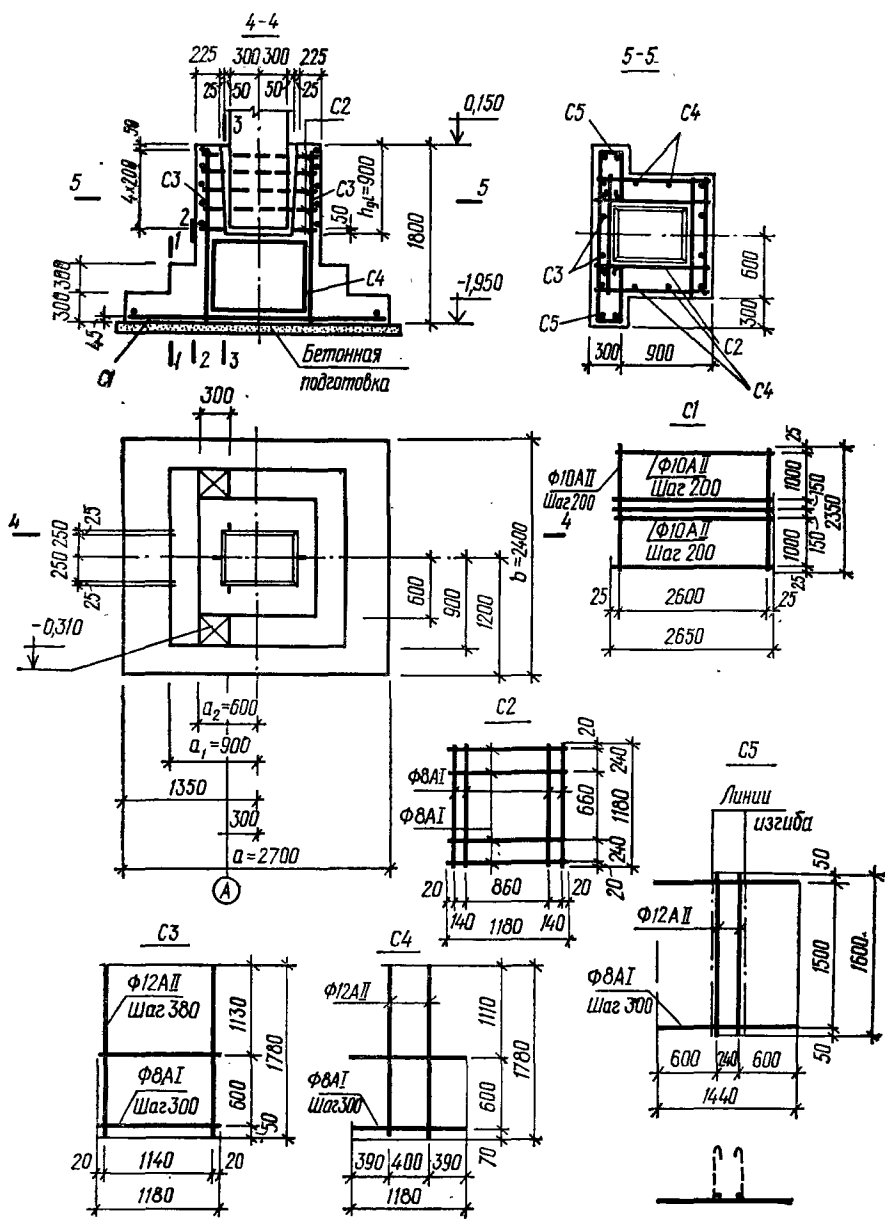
Конструкция фундамента под крайнюю колонну
